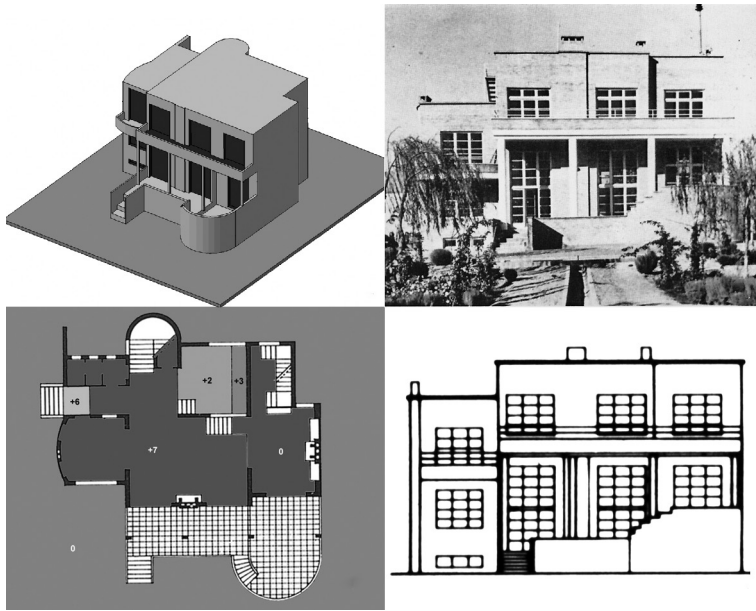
Villa Siassi, Teheran, Gabriel Guevrekian 1935. Isometrie, Grundriss, Foto und Aufriss Gartenseite.
